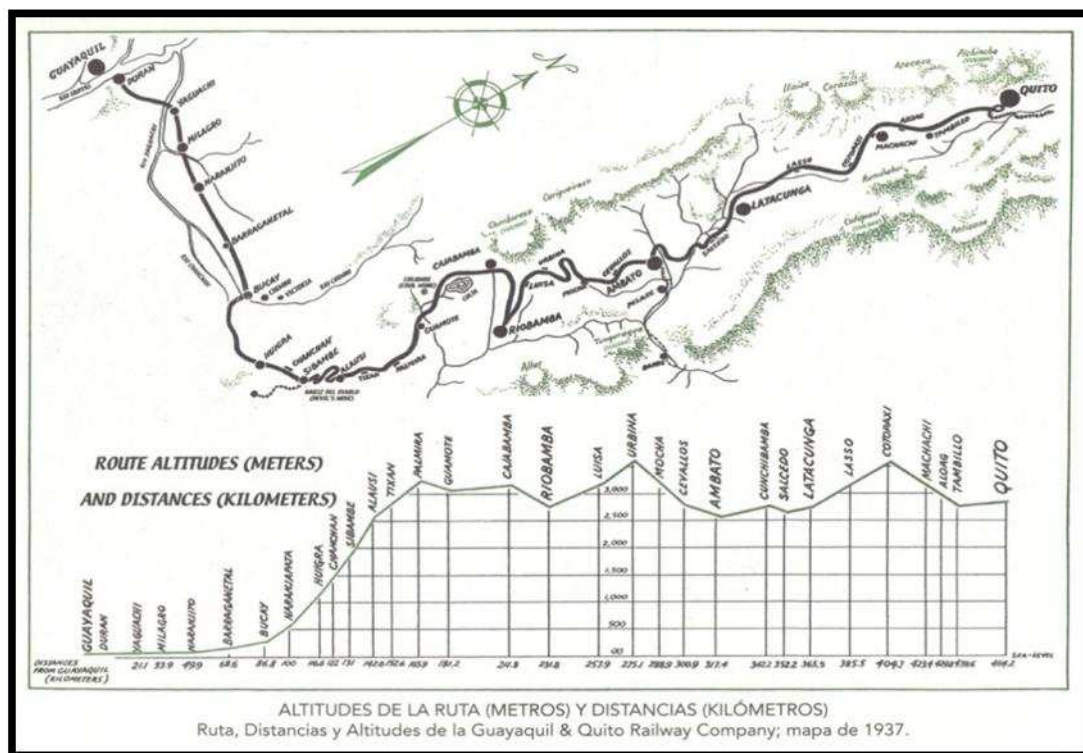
Perfil longitudinal y proyecto en planta de la Vía Férrea Durán –Quito.
